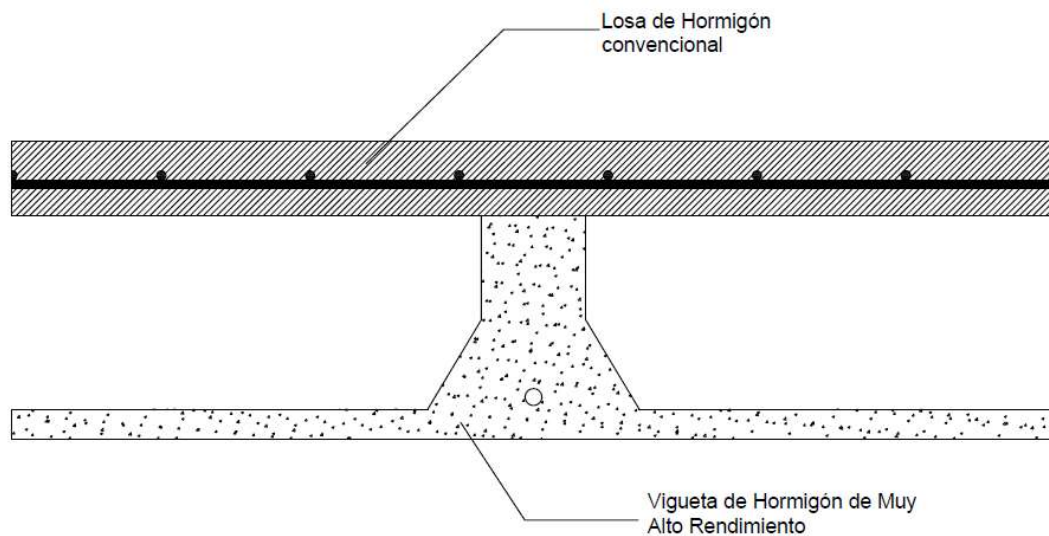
Imagen de la geometría adoptada para la alternativa con hormigón de muy alto rendimiento
